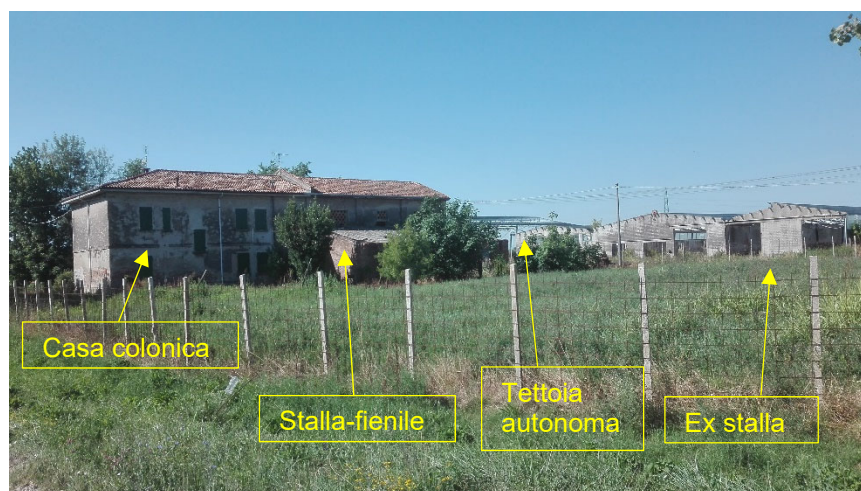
Vista delle tre strutture all'interno dell'area di proprietà
